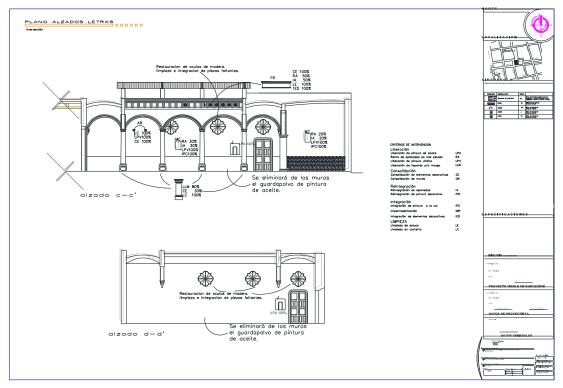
Plano de intervención Alzado. Eloísa Galván González. 2016
